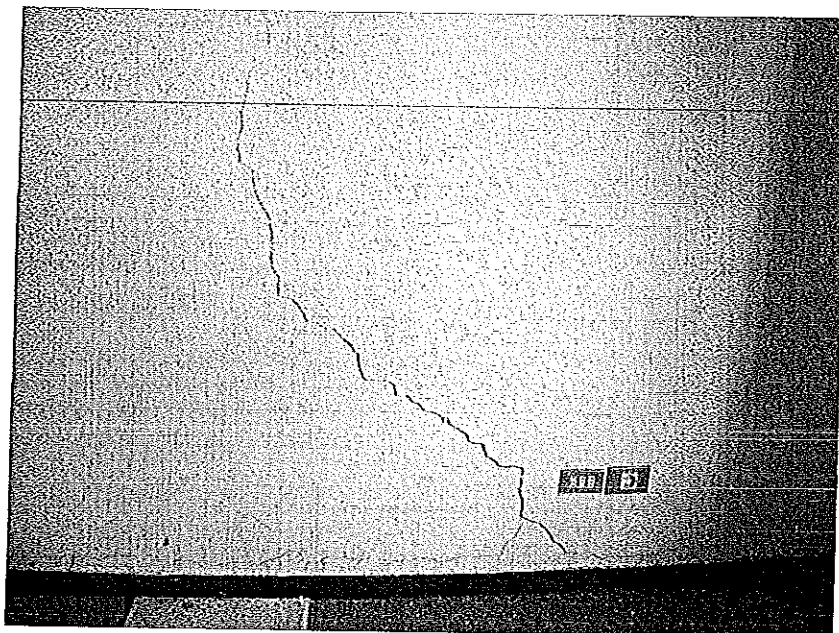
Crepa evidenziatasi sulle murature dell'appartamento – locale A.
